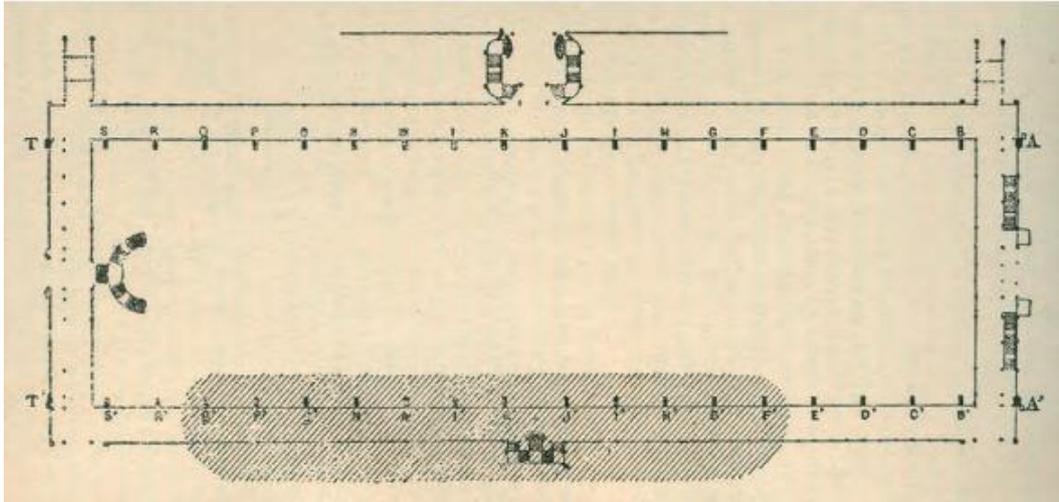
Planta de cimentación de la Galería de las Máquinas indicando los puntos de cimentación de los arcos triarticulados. La zona rayada corresponde a los doce puntos de cimentación de los arcos principales con cimentación por pilotaje. (Watson, 1892)
